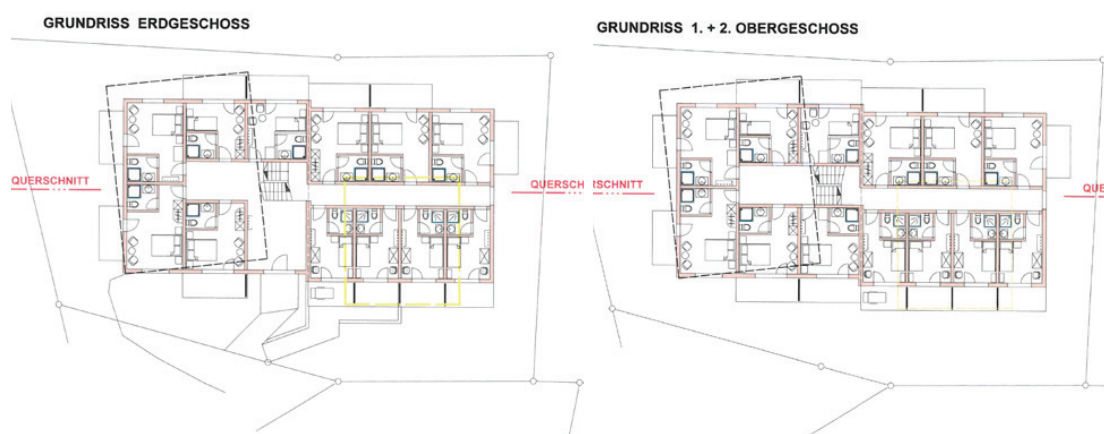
Grundrisse der geplanten Nutzungen und im Erdgeschoss und im 1. und 2. Obergeschoss im Chalet Elsbeth (Quelle: Gottfried Schmid, Mai & August 2025)
